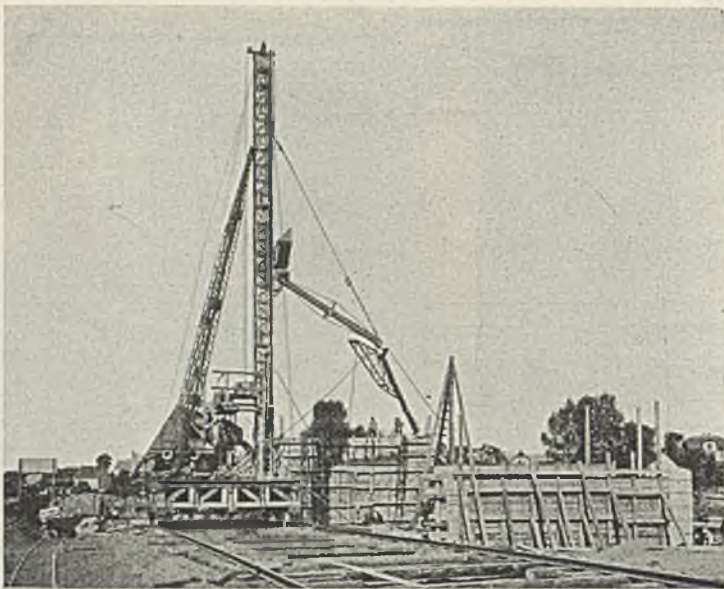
Betonieren der Flutbrückenpfeiler (Gießturmanlage).
